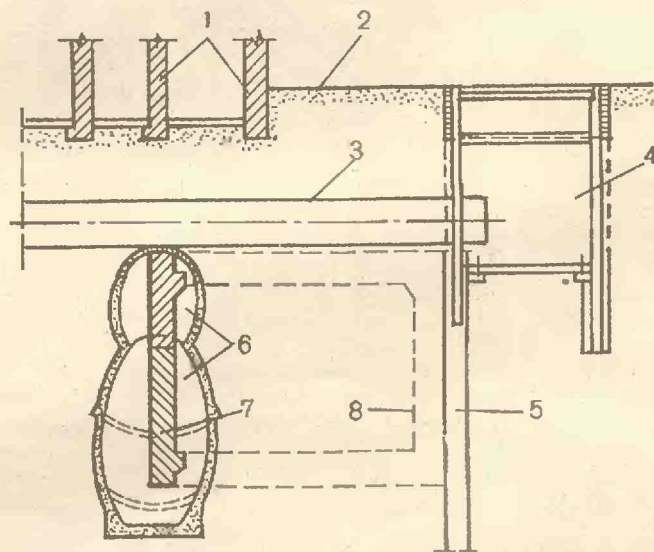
Схема опорно-ограждающей конструкции со стеной, возведенной в штольневых выработках:
